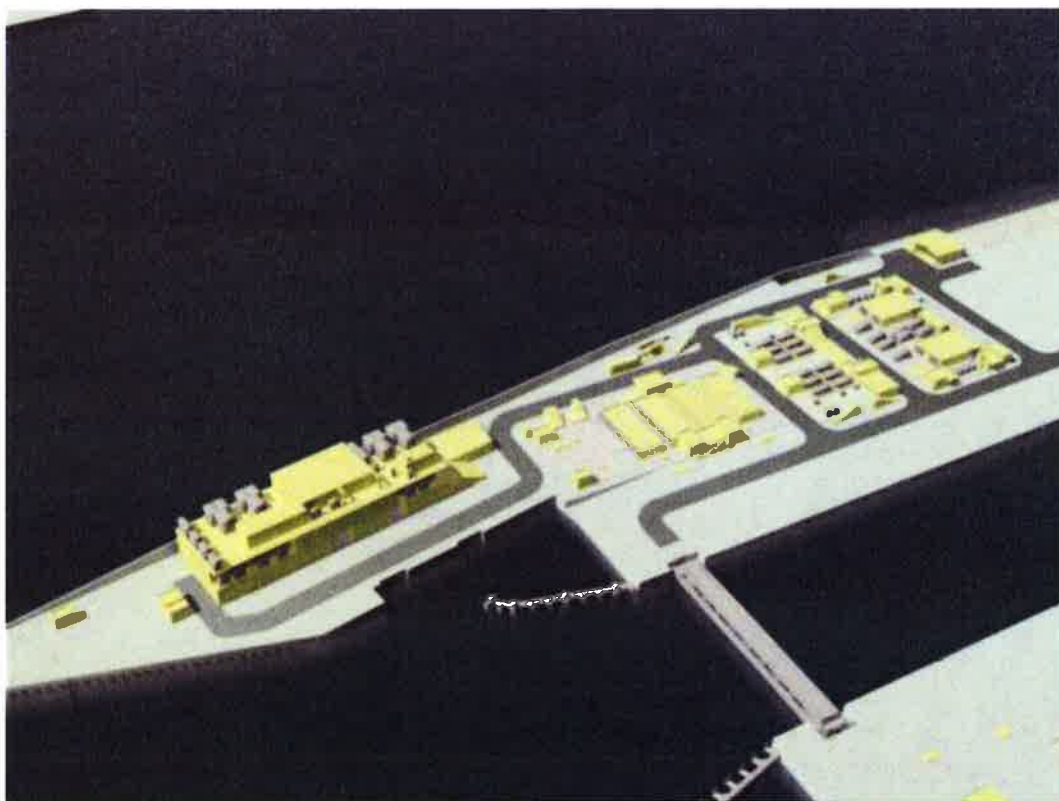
RENDERING PRELIMINARE DELL'AREA IMPIANTI PRESSO LA SPALLA DI MALAMOCCO
